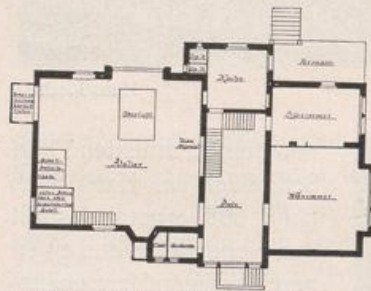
Villa Waldfrieden. Erdgeschoss.
